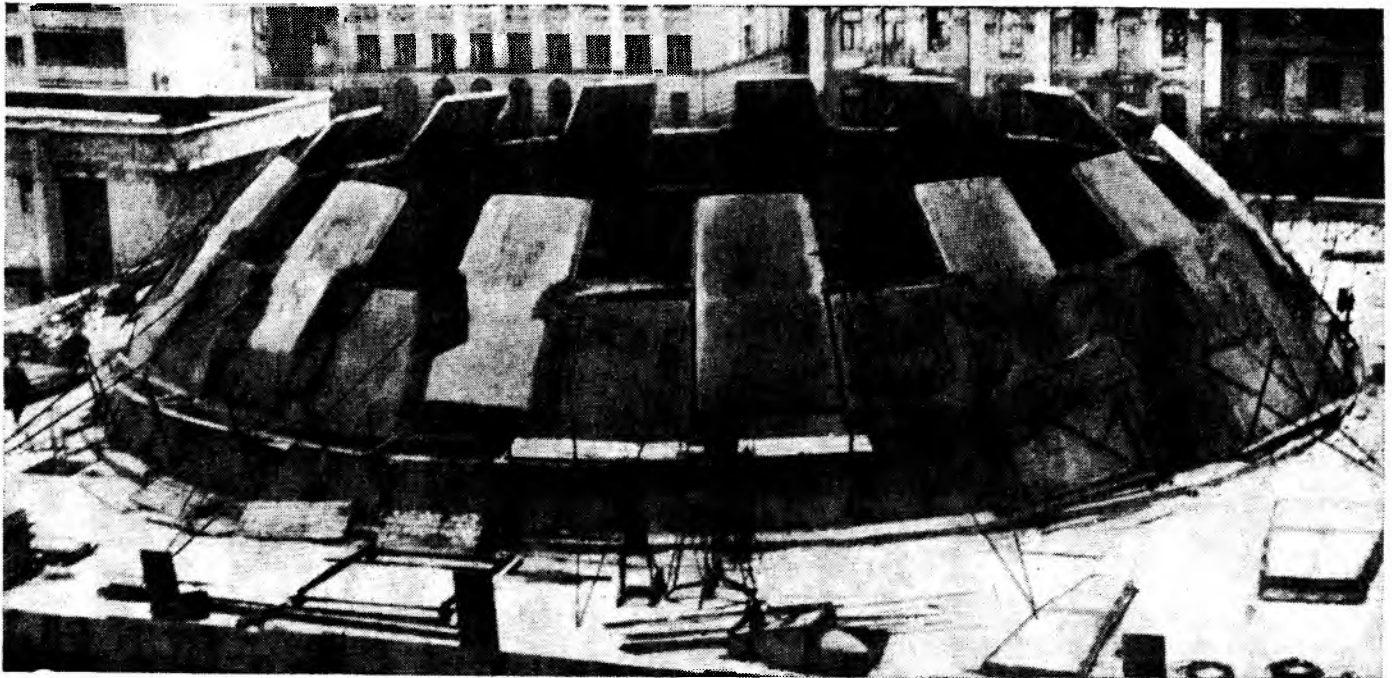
Монтаж сборного железобетонного купола в Киеве
